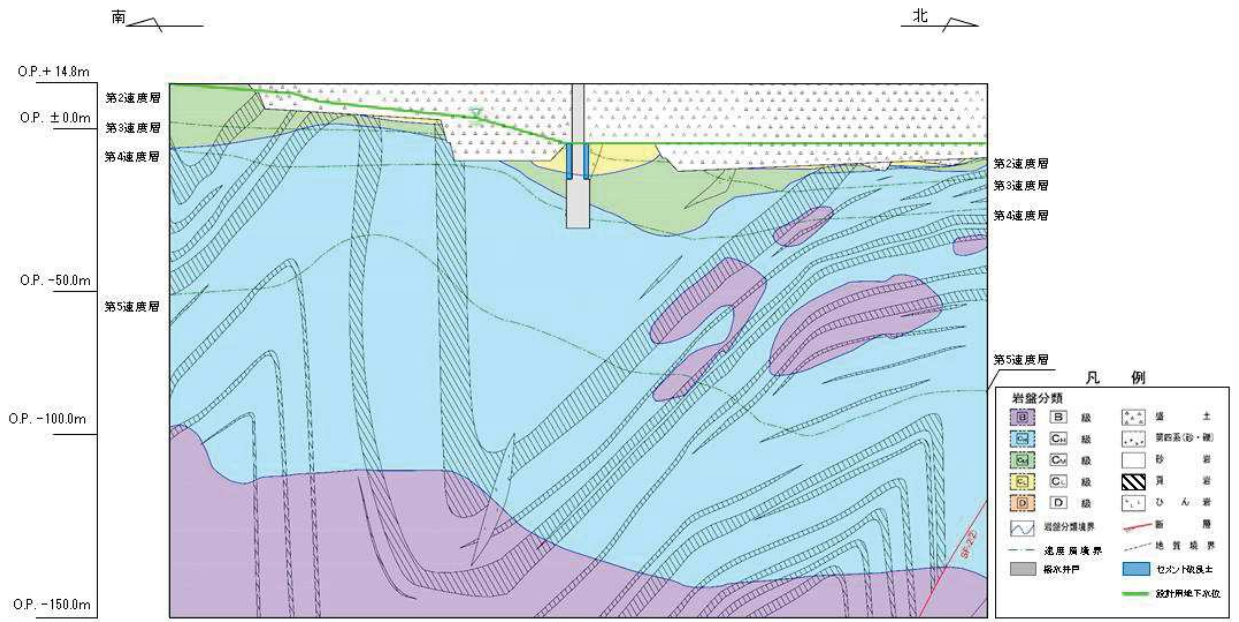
(1) No.1 揚水井戸 評価対象断面図 (A'-A断面)
